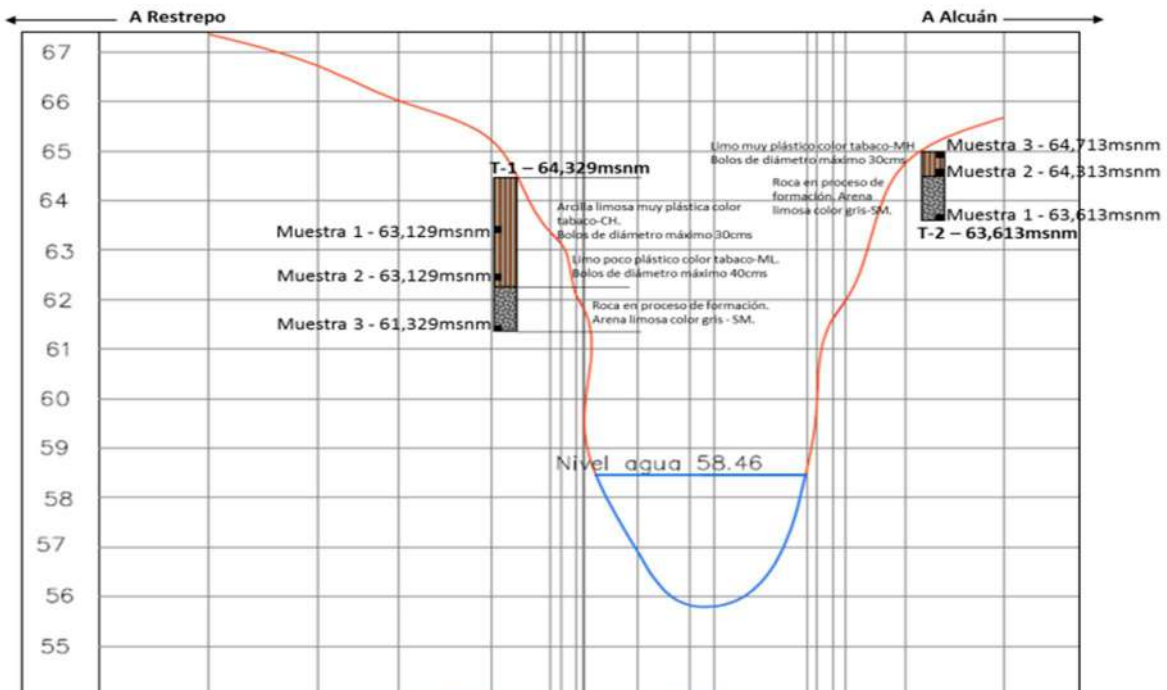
Estratigrafía ESTRIBO NORTE, trinchera T-2 y ESTRIBO SUR, trinchera T-1.
